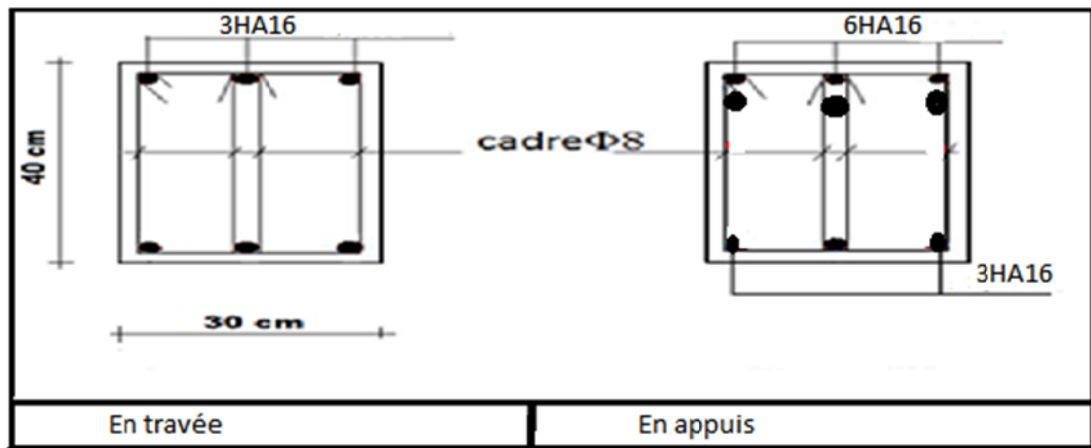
Schémas de ferraillage des poutres secondaires.
